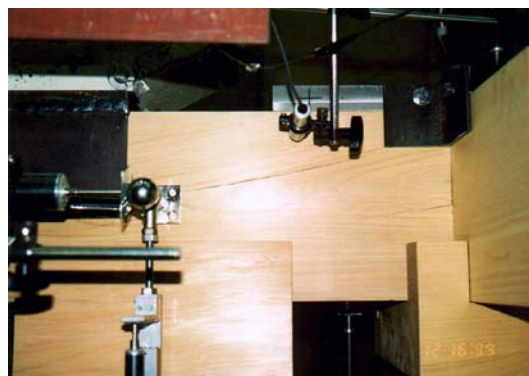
通し肘木のひび割れ(南面・西側)
